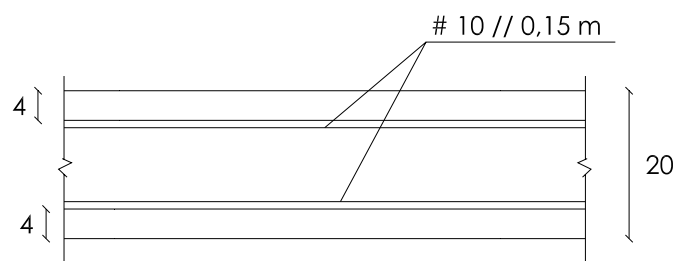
Secção transversal da laje de cobertura e térrea (medidas em cm)
